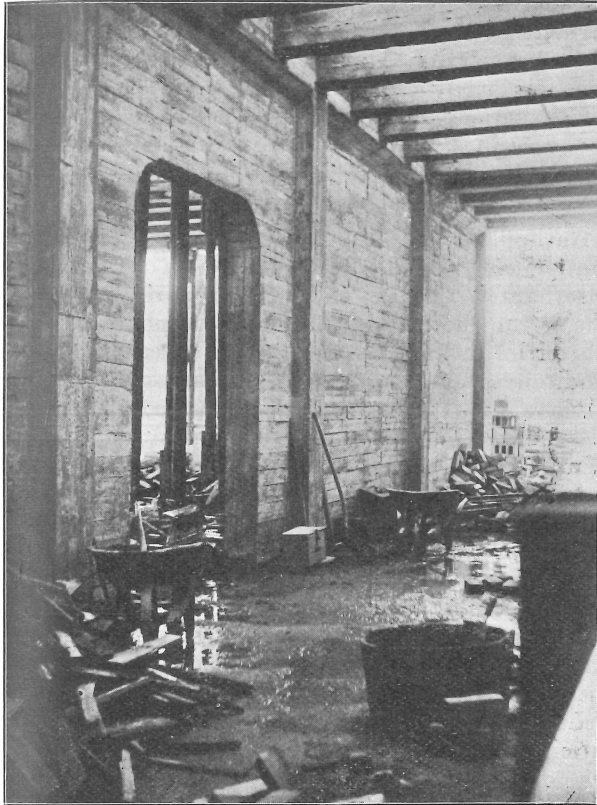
Poutre-cloison en béton armé de 20 m de portée (Institut du Génie Civil, 1934).
